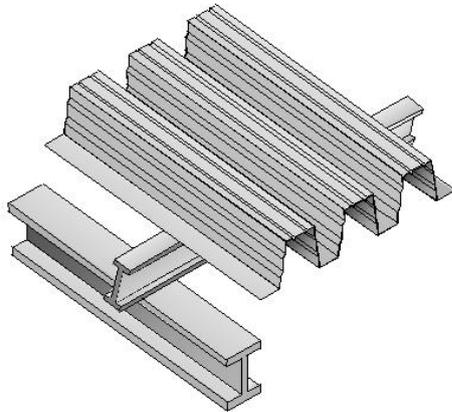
Querschnitt eines Pfettendachs mit Trapezblech Bild 4.21 Drehbettungsanteile [11]
